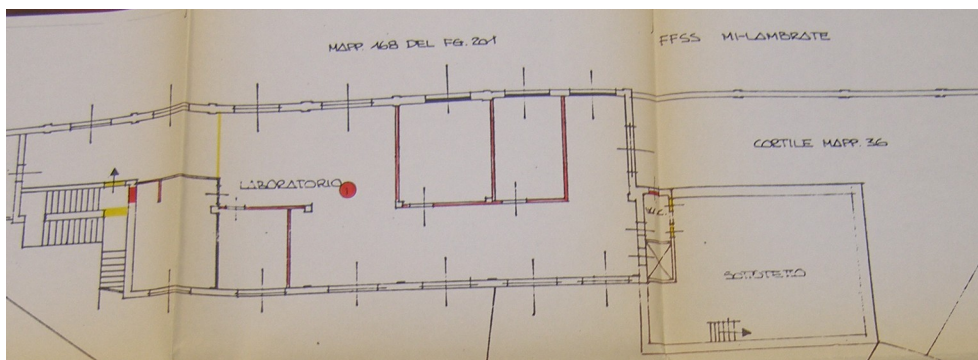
estratto Planimetria piano II Condono N 1910 Atti 309322/1985
